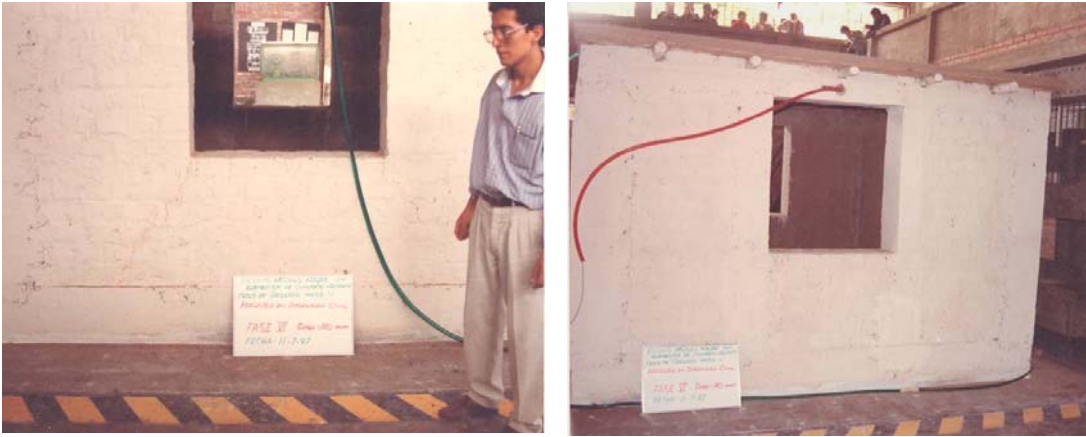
Fisuras después de la Fase 6 (D = 140mm). Eje B (izquierda) y eje A (derecha).
